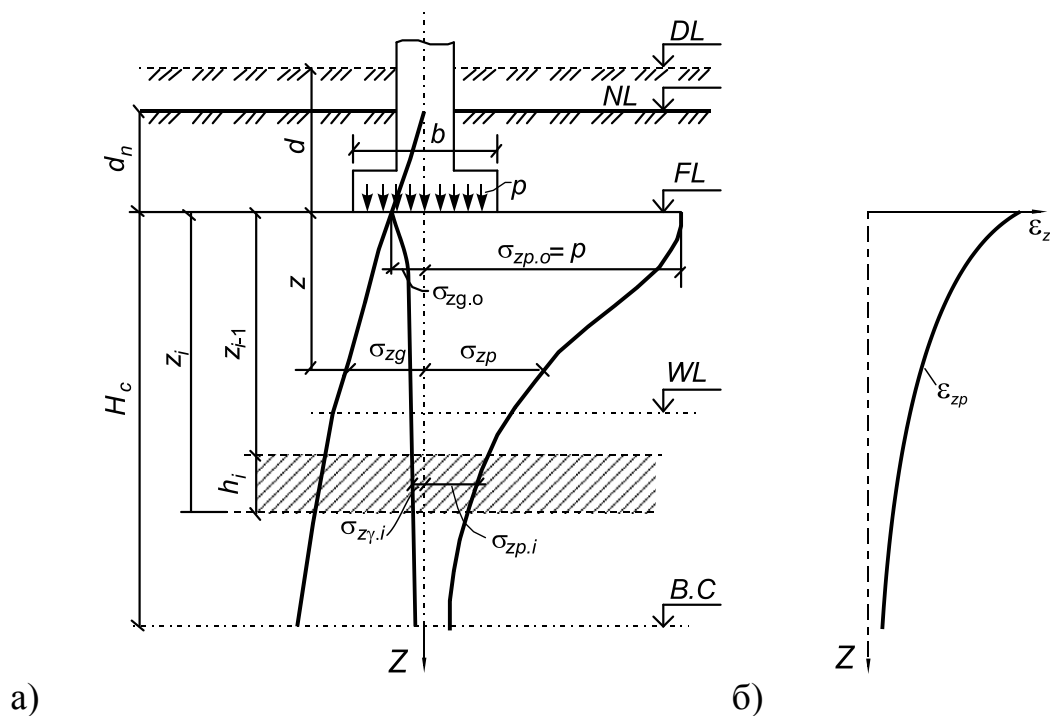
Расчетная схема к определению осадки фундамента (а) и эпюра вертикальной деформации (б)
